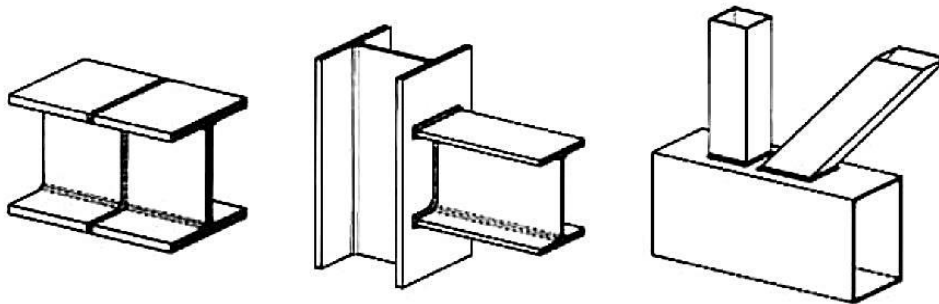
exemple d'assemblage soudé. [1]
